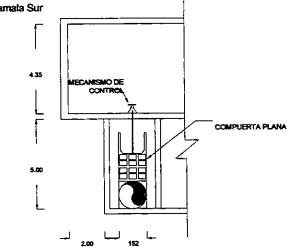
Vista Frontal del Control hacia las Derivaciones del Sistema Cutzamala Sur (Corte B-B')
